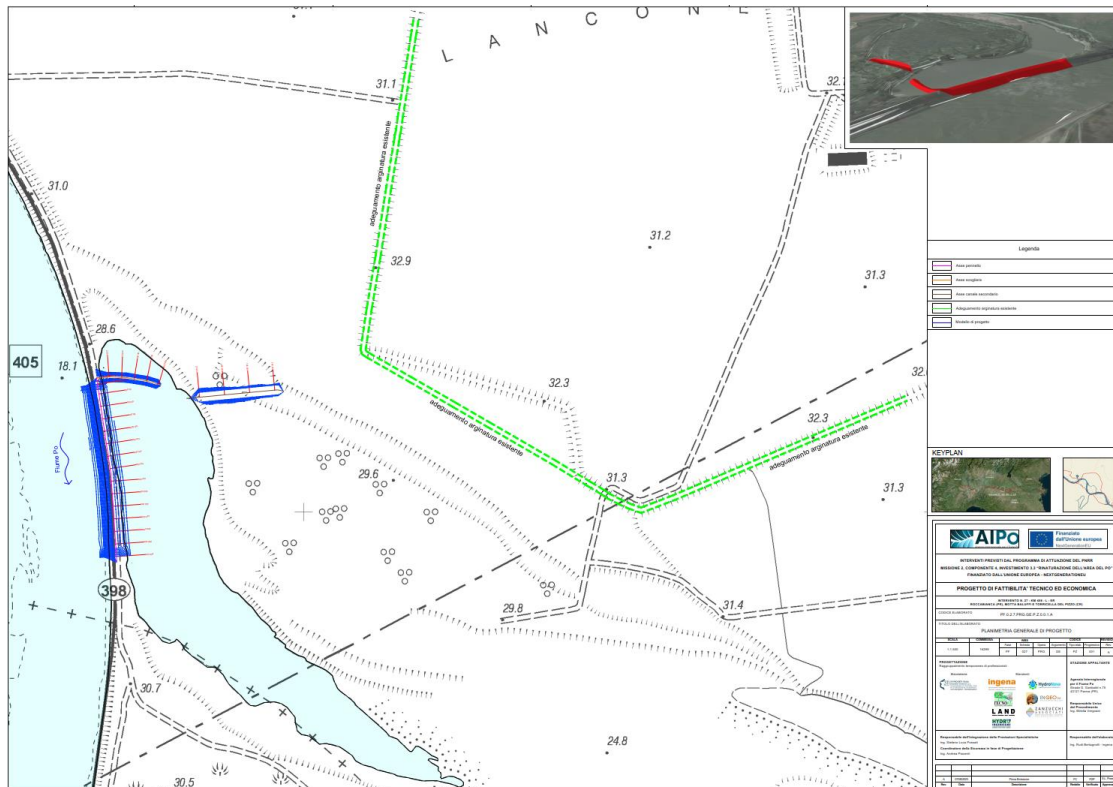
Planimetria di progetto degli interventi previsti. Estratto della Tavola P.F.0.2.7.PRG.GE.P.L.0.0.1.A.
